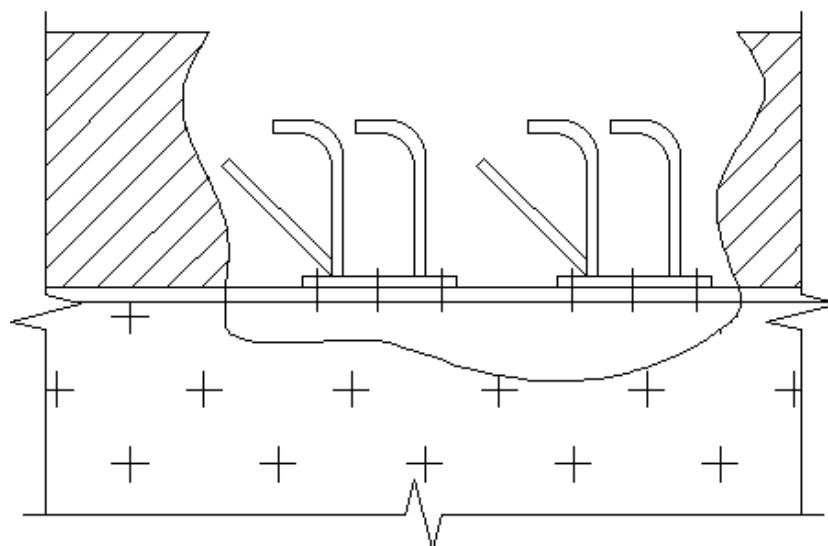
Узел объединения в совместную работу композитной балки пролетного строения и железобетонной плиты проезда [22]
